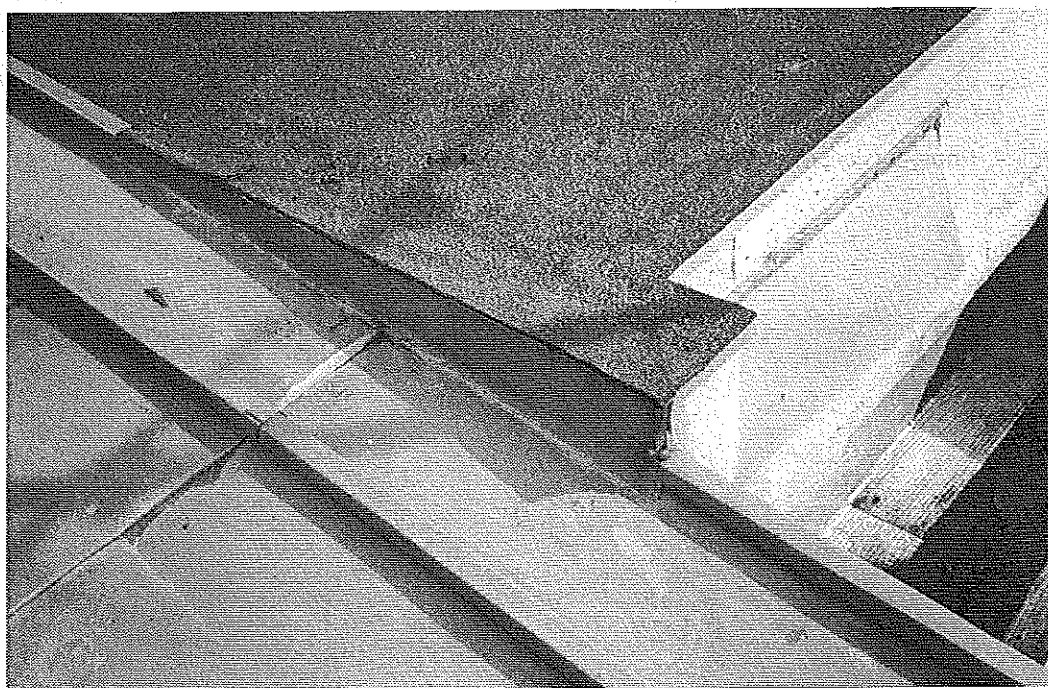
Raccordement travée de rive avec ouvrage en limite (terrasse plate avec revêtement d'étanchéité). © J. Putatti.
